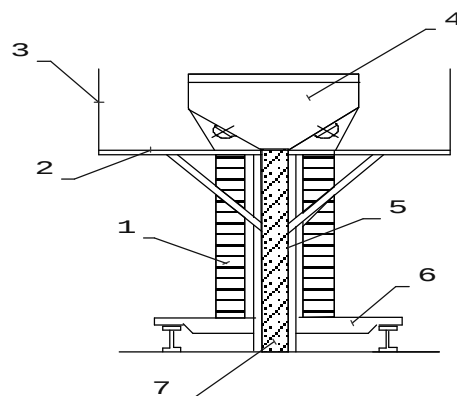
Котюча опалубка для бетонування стін: 1 – колони portalу; 2 – настил; 3 – огороження; 4 – бункер; 5 – щит опалубки; 6 – візок; 7 – конструкція, що бетонується
